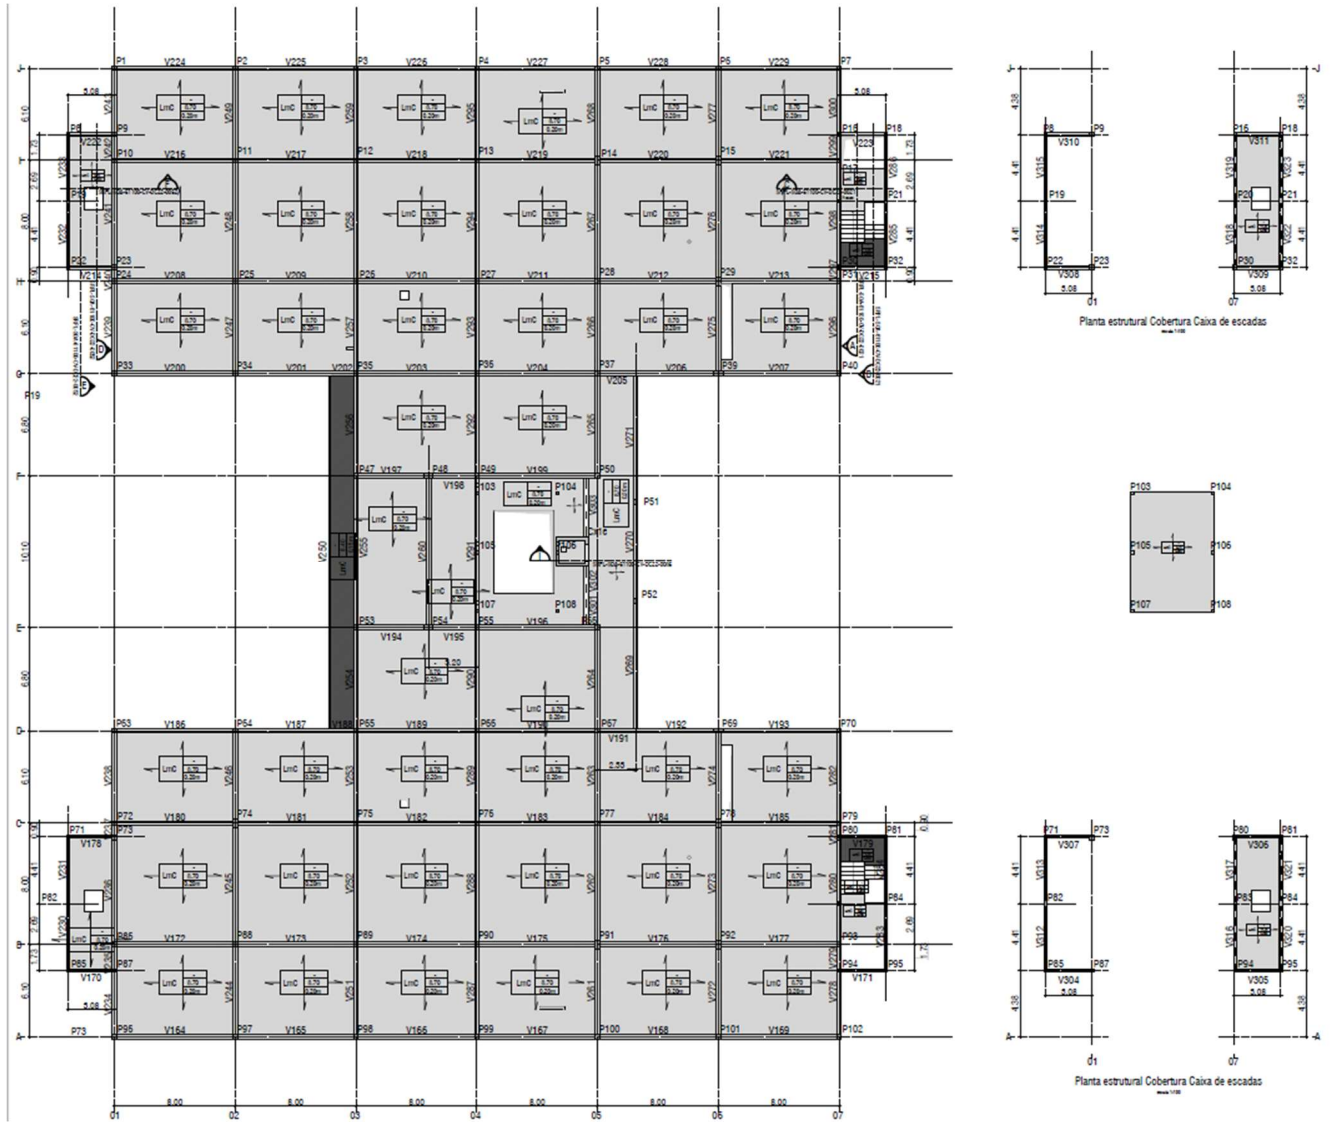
Planta Estrutural das Coberturas do Projeto Executivo
